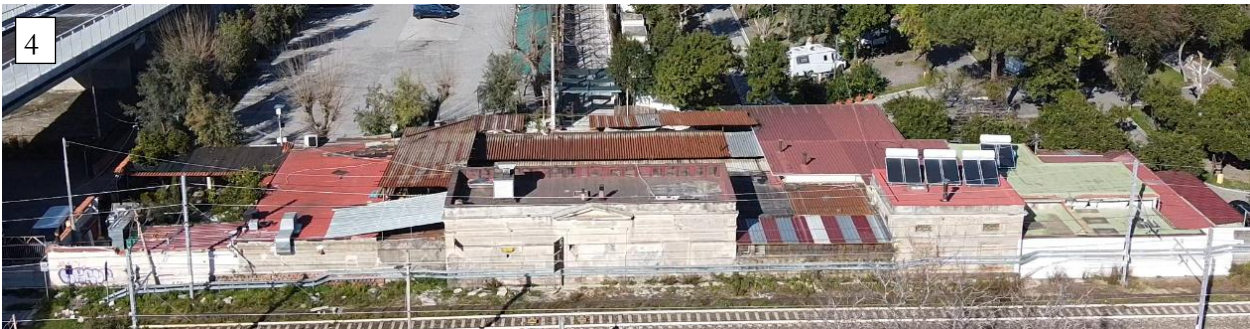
Stato di fatto fabbricati dell'antica Fermata Pompei Scavi – Vista dall'alto dei fabbricati storici circondati da strutture di nuova costruzione
